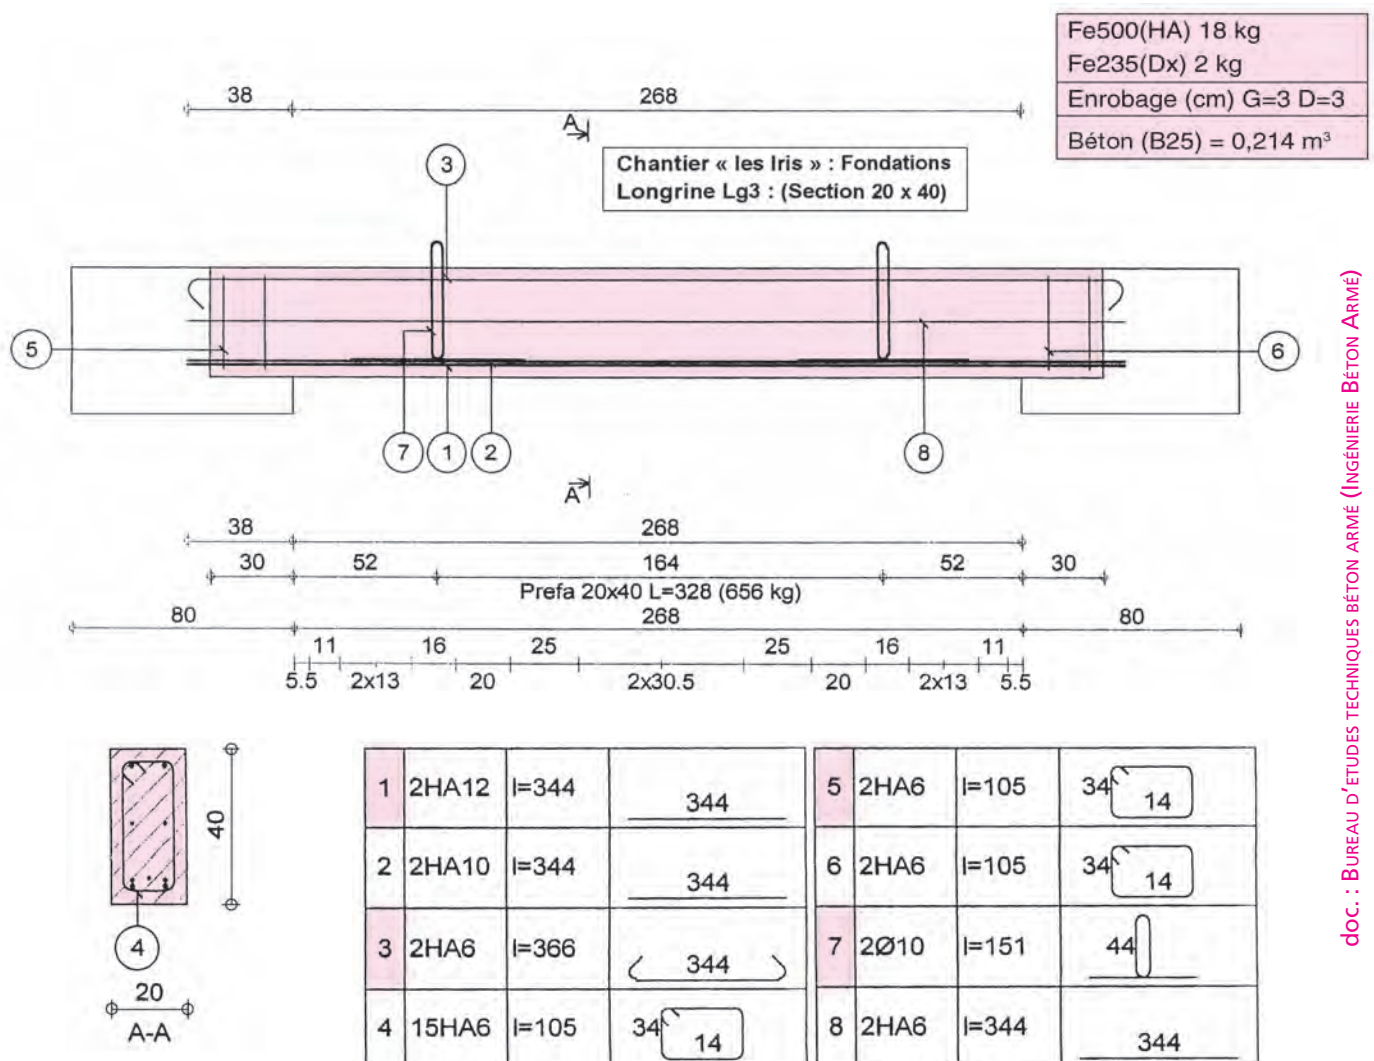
Détails de l'armature de la longrine Lg3 de section 20 x 40
